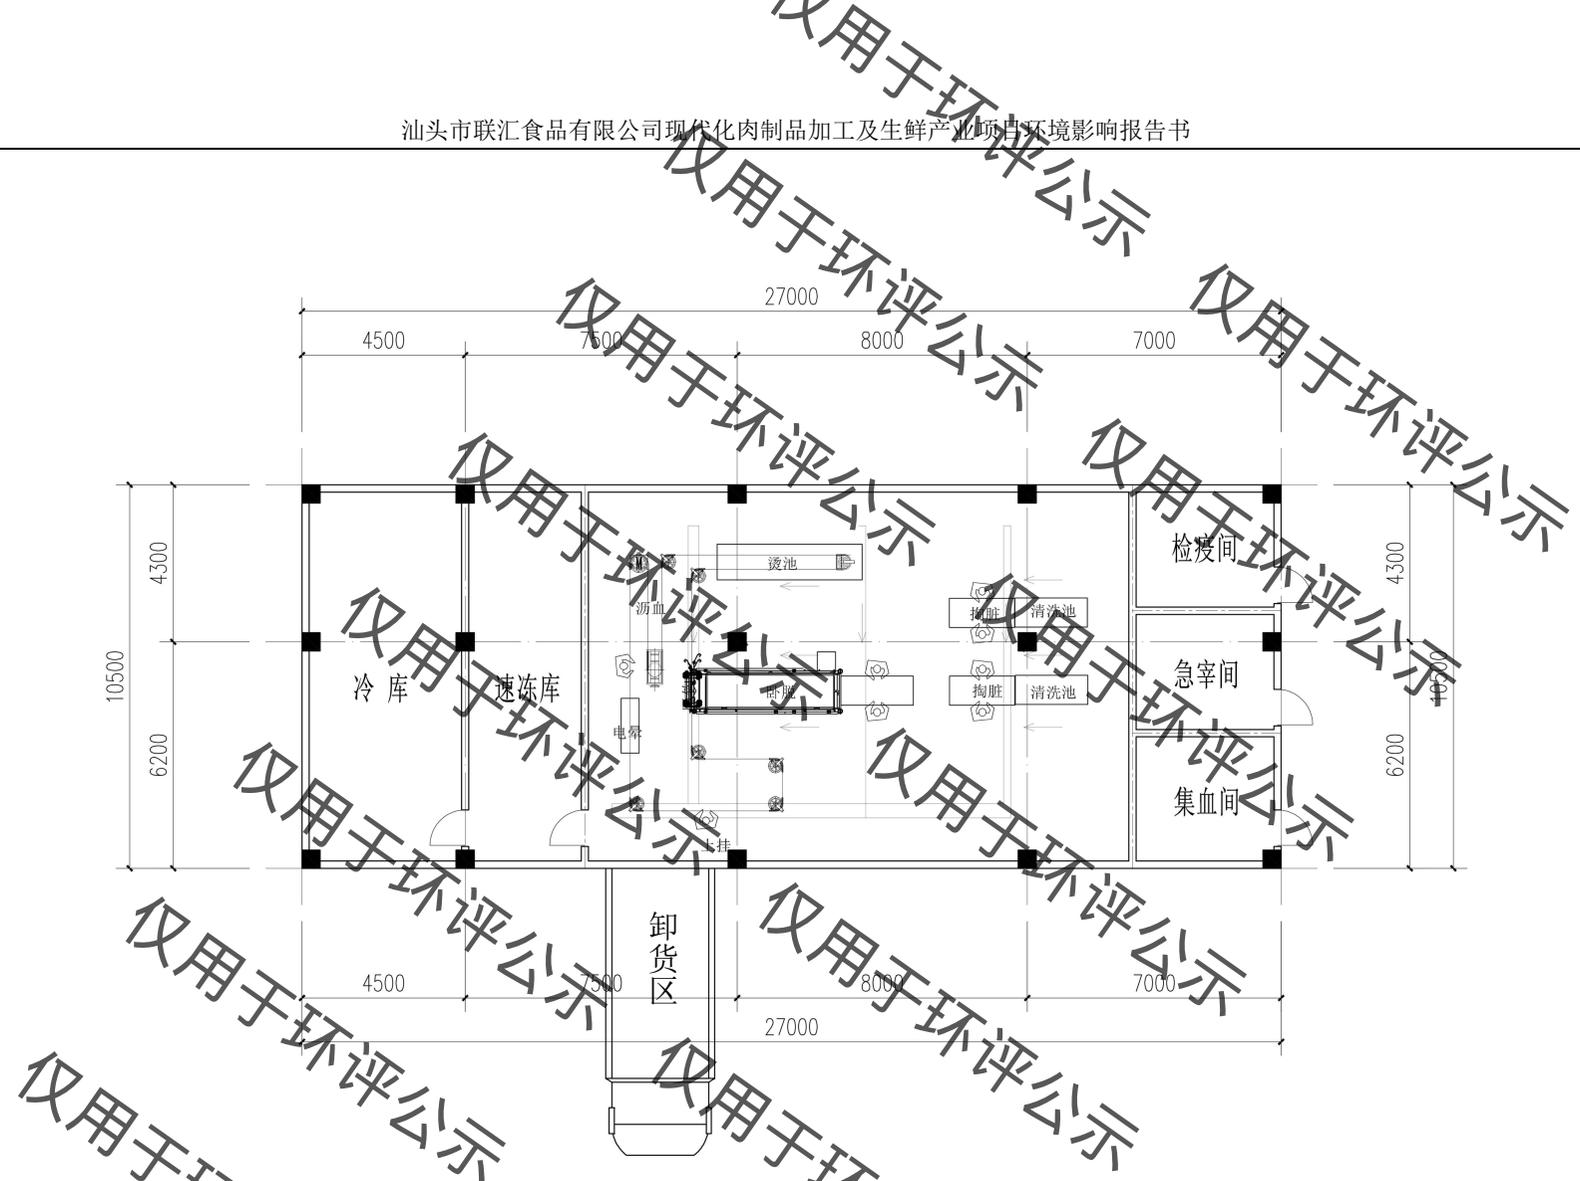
牛羊屠宰车间平面布置图（首层）
